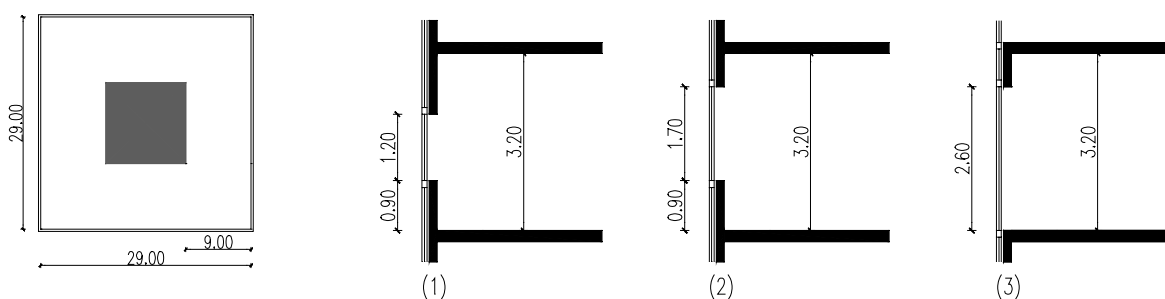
Planta tipo con núcleo central y secciones de las diferentes alternativas de aberturas.
